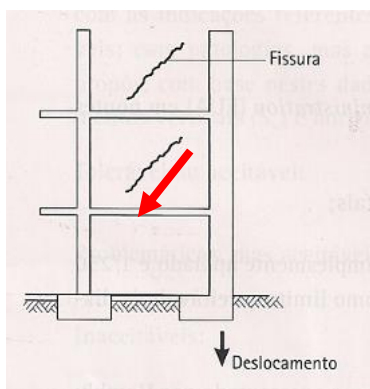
Fissuras por recalque de fundação de pilar de canto.
